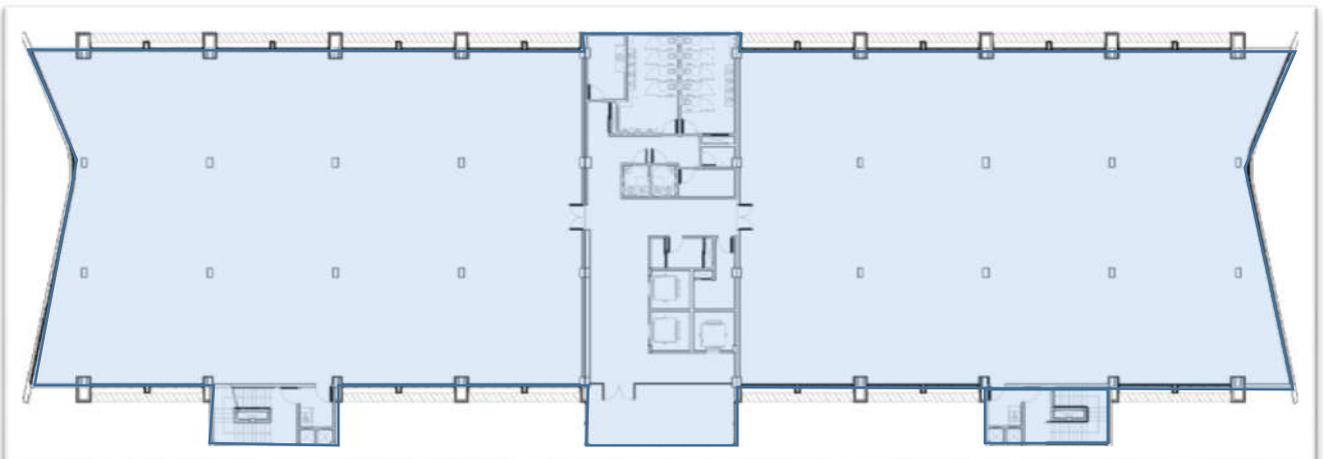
Planta Baixa 4º Pavimento SEDE TRE/AC (área de expansão)
